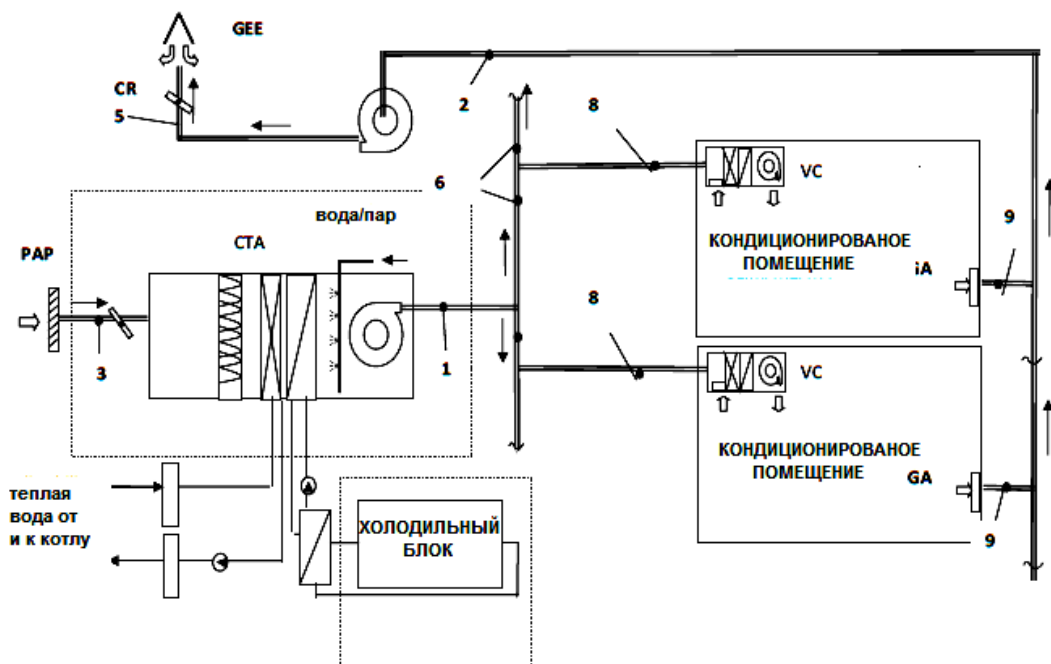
Схема установки кондиционирования с вентиляторным доводчиком; механическая вентиляция, с обработкой воздуха:
